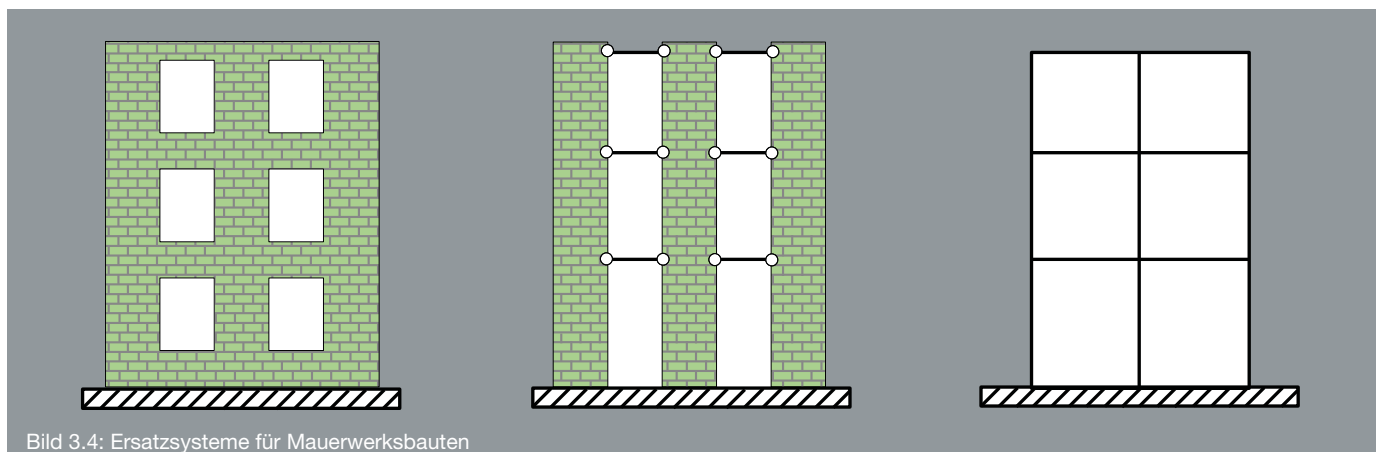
Ersatzsysteme für Mauerwerksbauten
